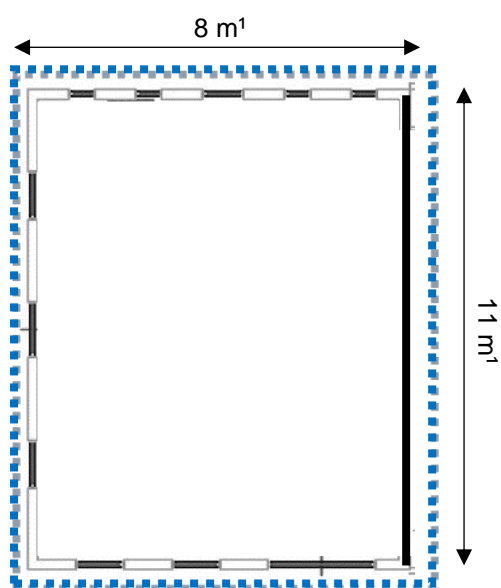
Buitengevel: Beglazingskit (Niet asbestverdacht)
